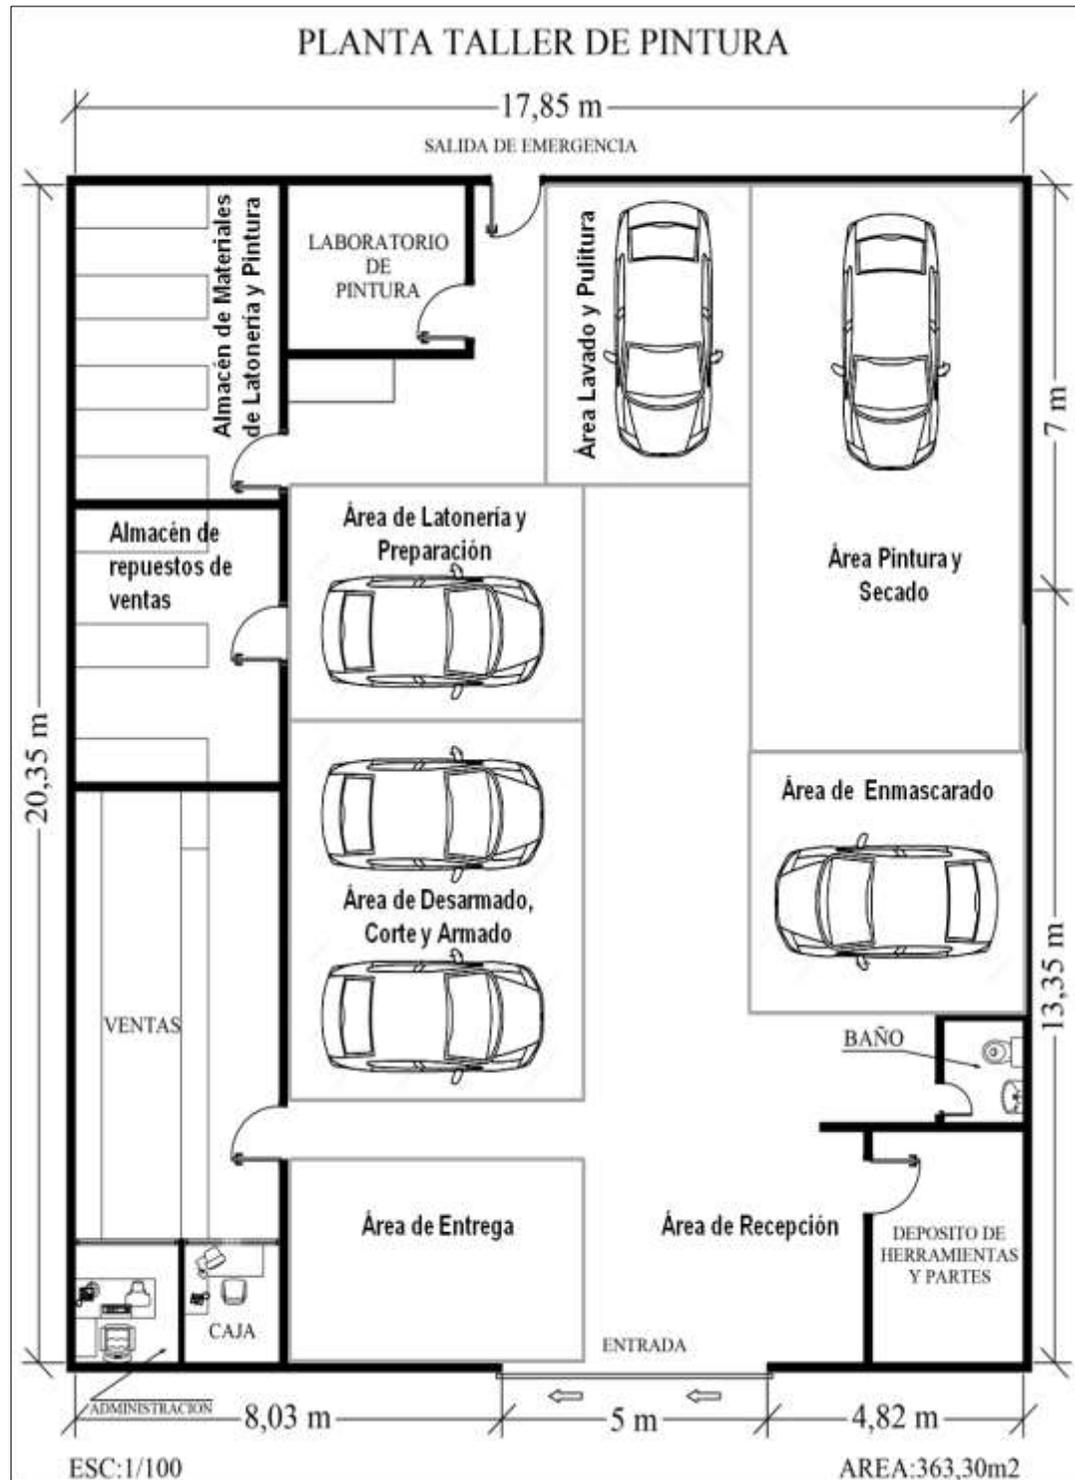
Plano distribución actual de planta Julior, C.A.
